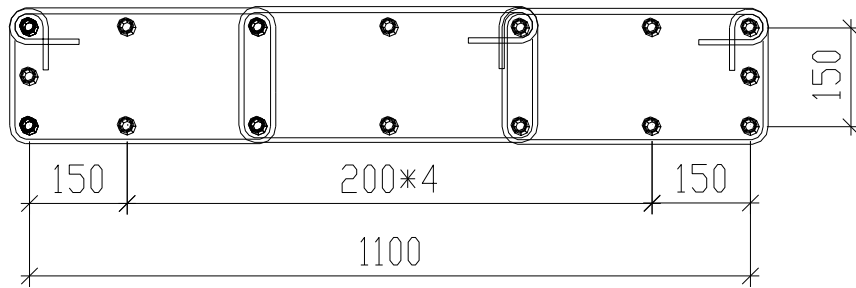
Горизонтальний переріз стінової арматури SC між дверима
